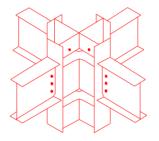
型钢混凝土 内型钢梁柱节点 及水平加劲肋
